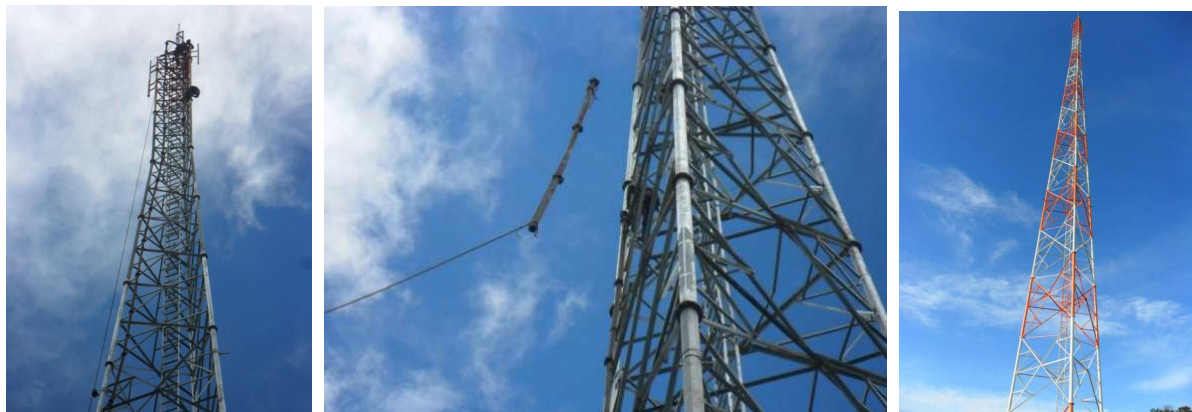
torre 70m com concretagem interna das colunas após montada – aumento do carregamento admissível em 41%
